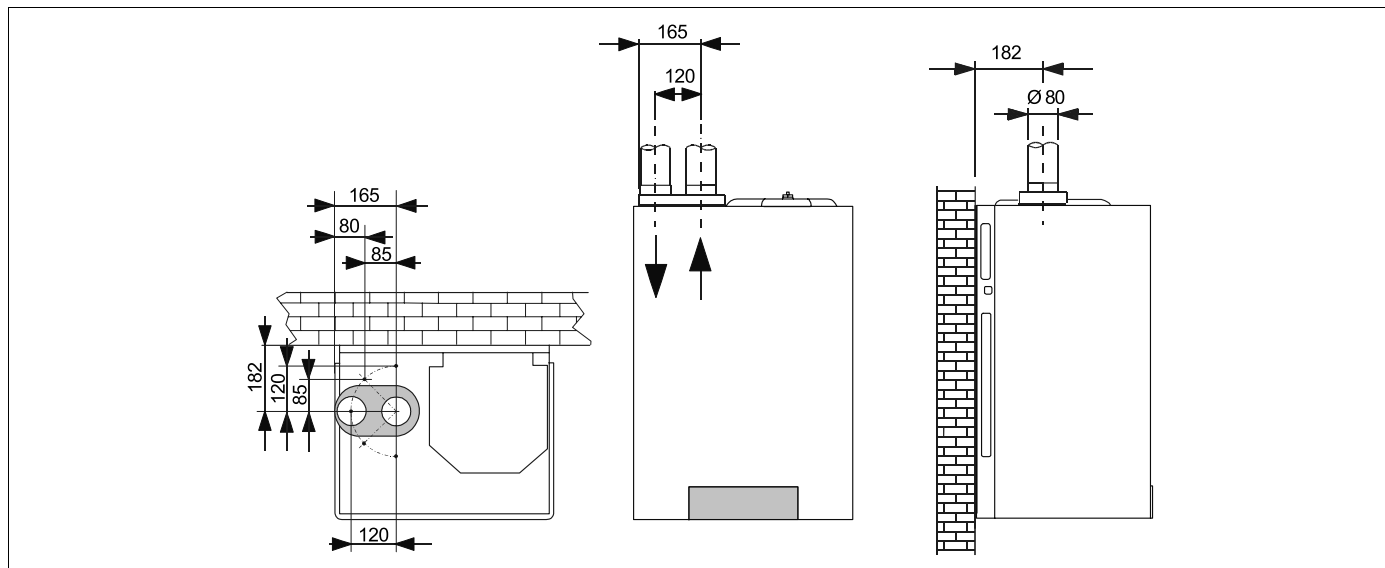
Příklad se dvěma paralelními trubkami spalin (rozměr v mm)
